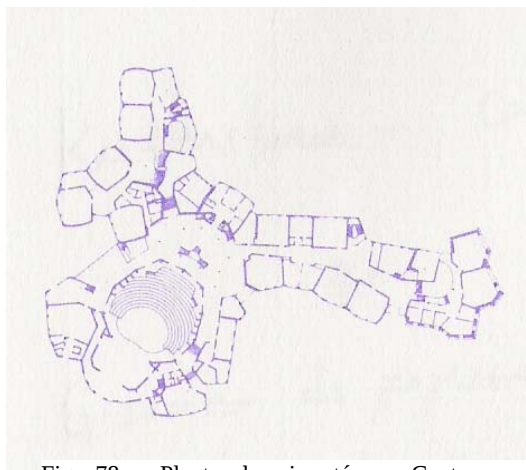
Planta do piso térreo. Centro escolar Waldorf, Uberlingen, Alemanha (Wilfried Ogilvie).
